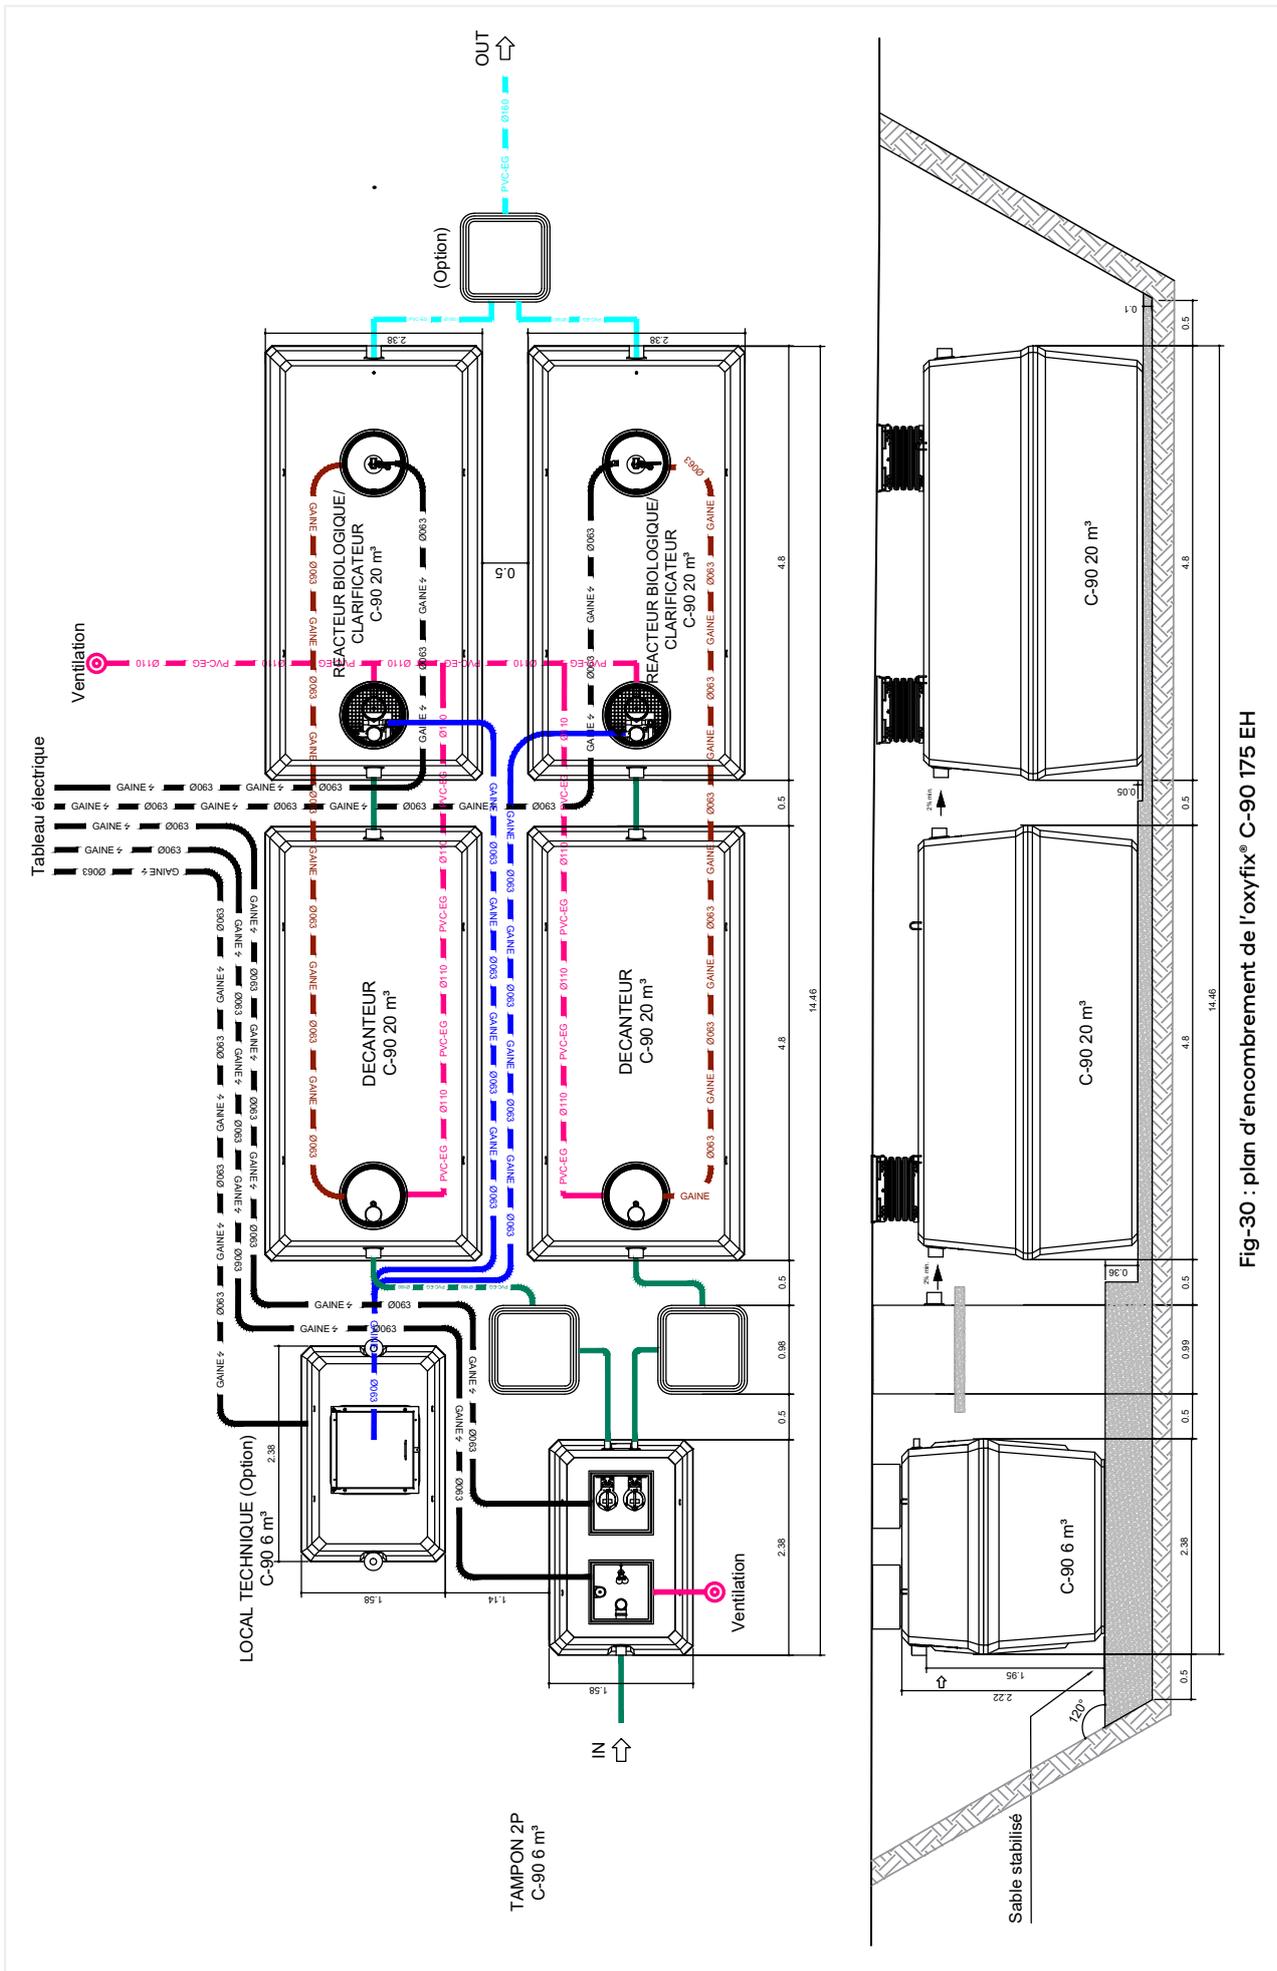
plan d'encombrement de l'oxyfix® C-90 175 EH
